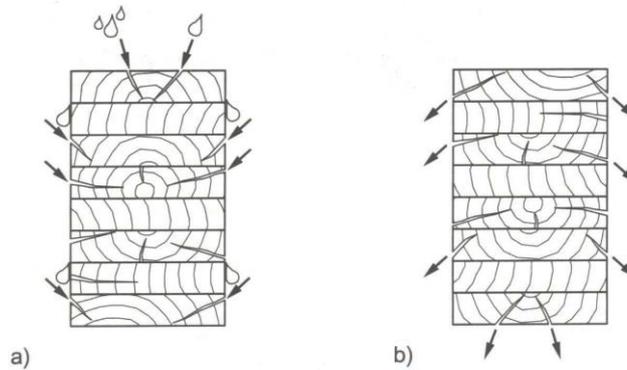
Effetto dell'orientazione di una trave in legno lamellare sulla possibilità di assorbimento di acqua.
